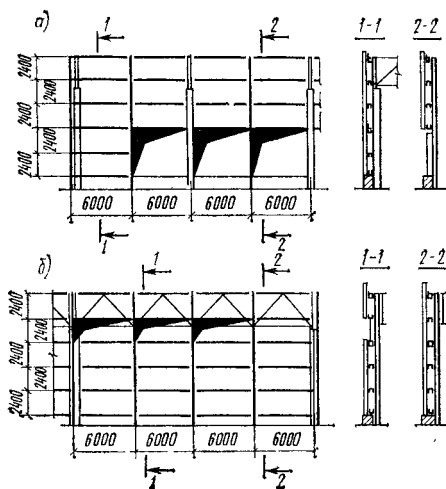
Схемы фахверка наружных стен из бескаркасных металлических трехслойных панелей
